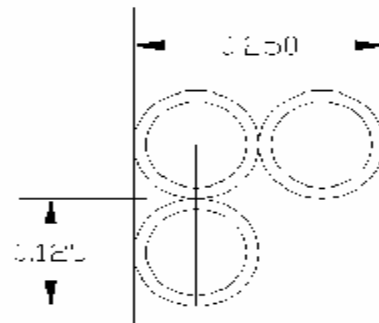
Sección Transversal de una columna tipo 3 (en cm)
